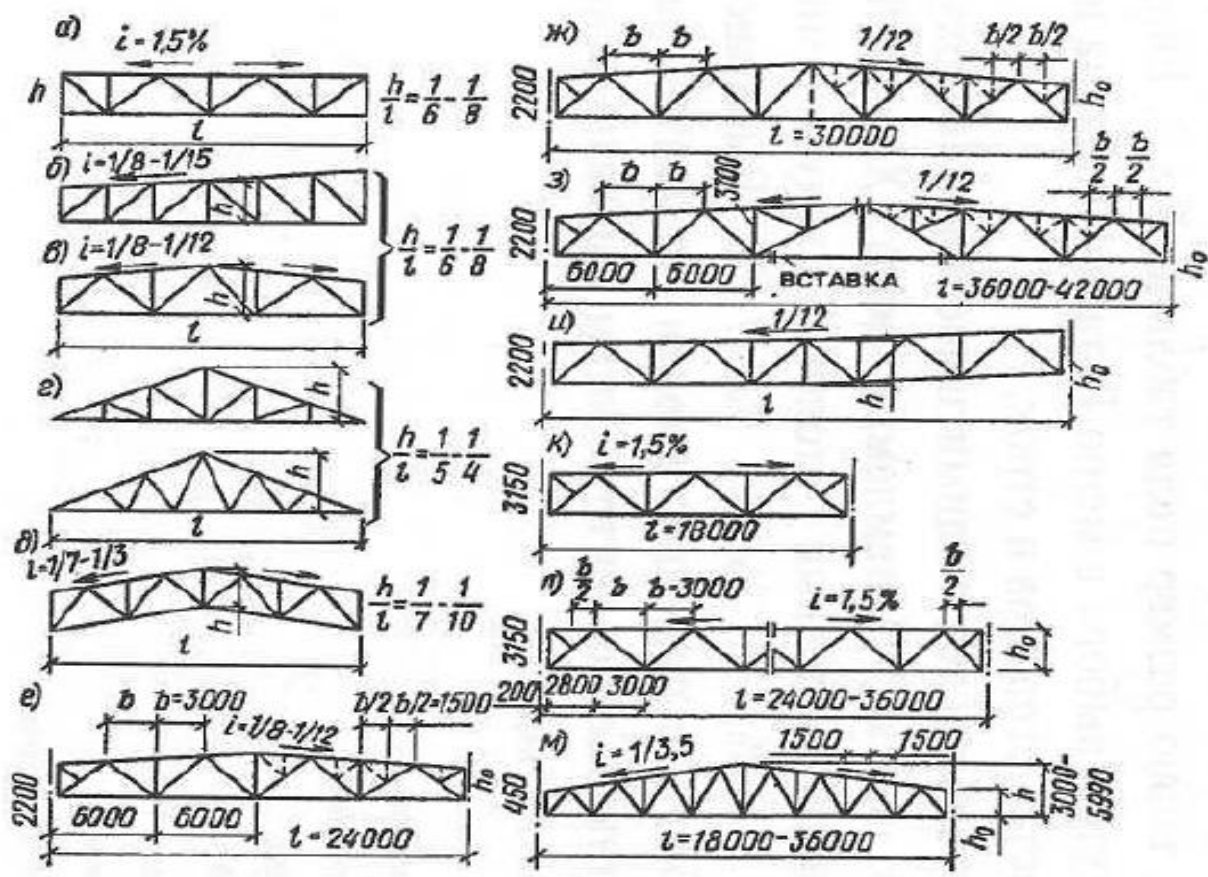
Назначение высоты стропильных ферм на опоре и в коньке
